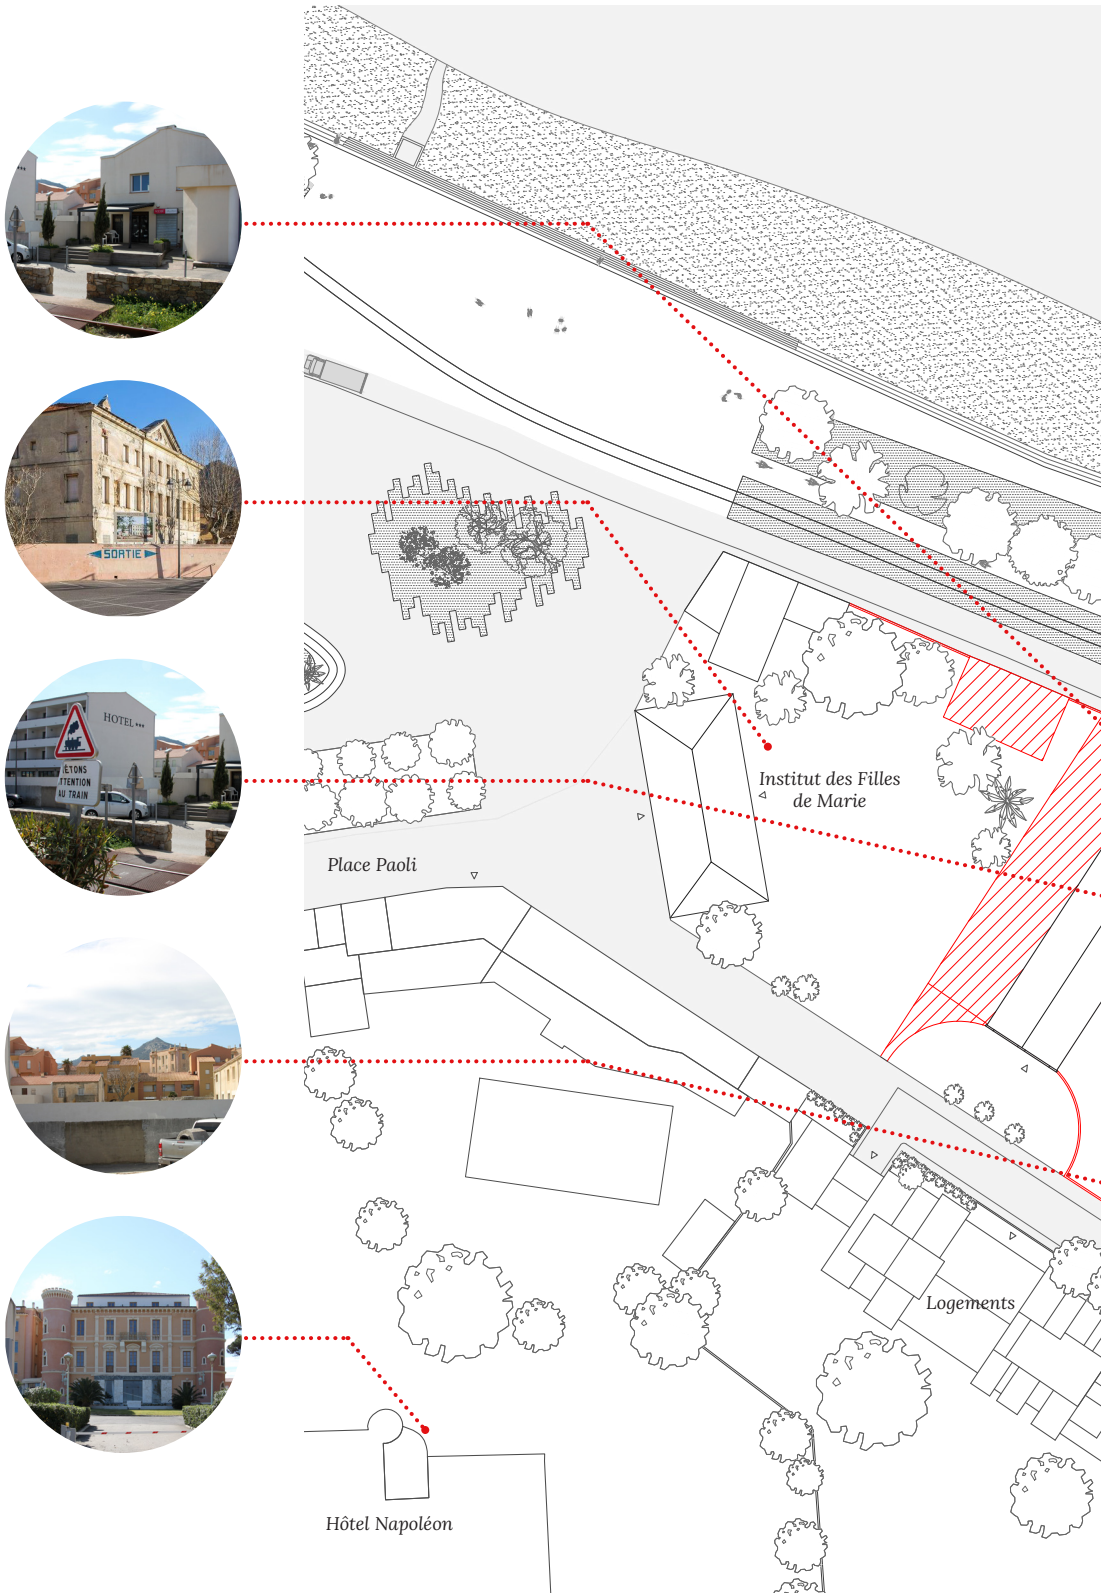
Un existant hétéroclite, entre architecture balnéaire et bâti patrimonial - Plan masse existant
